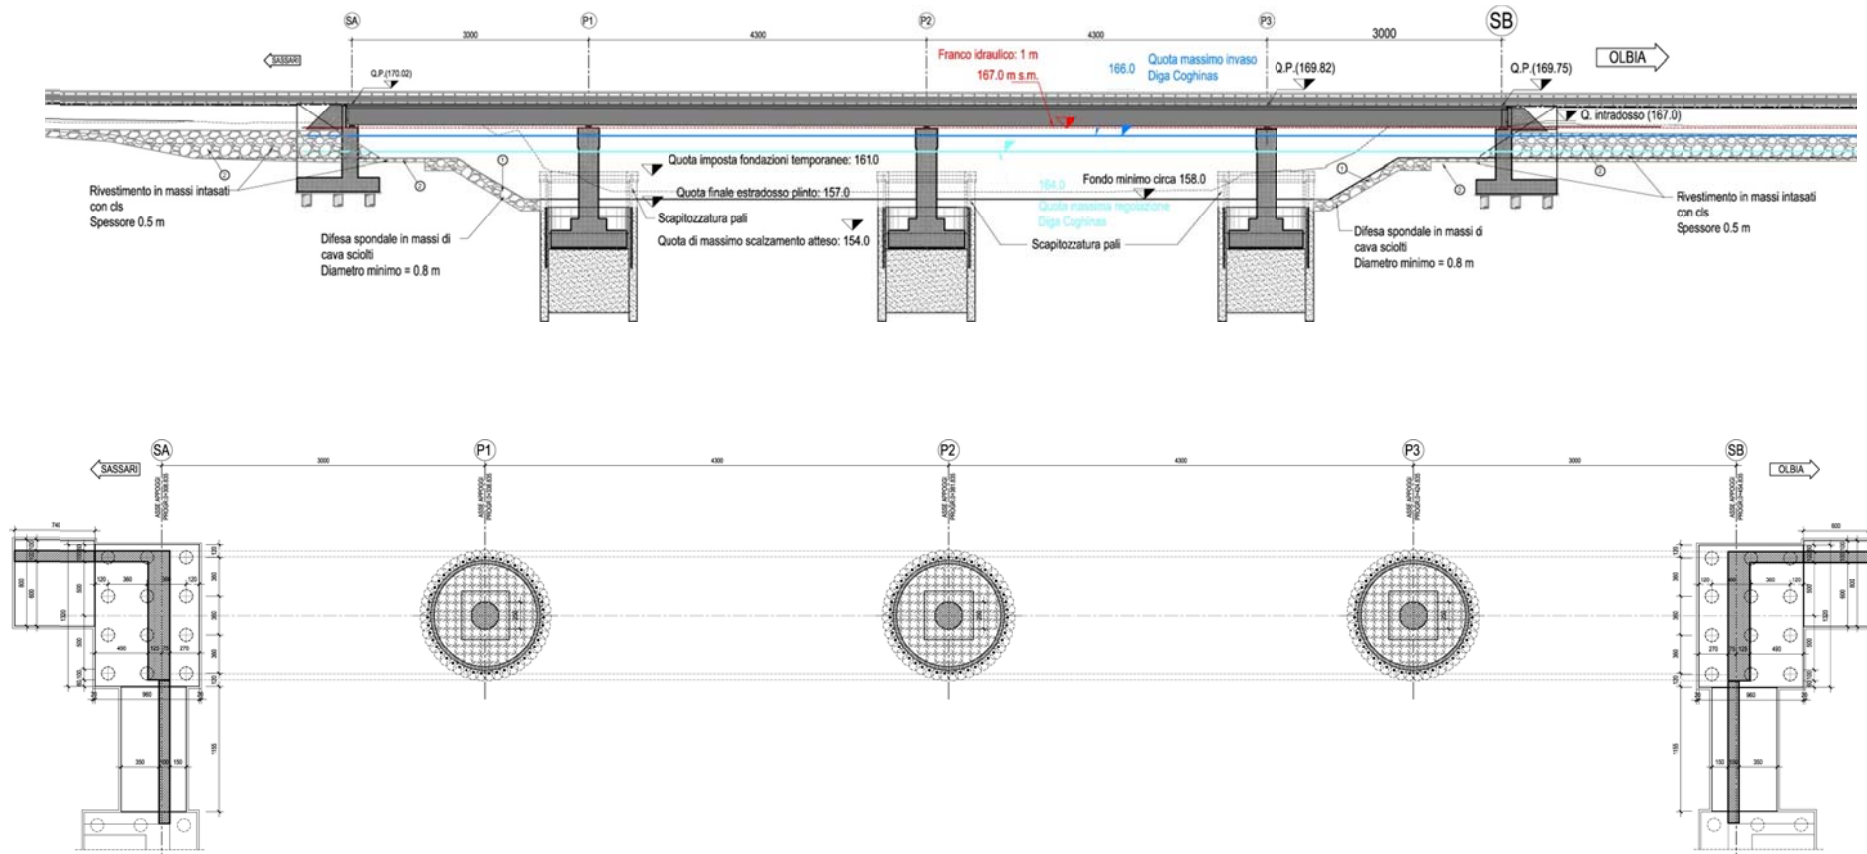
Sezione longitudinale e planimetria del ponte della SV7 in progetto
